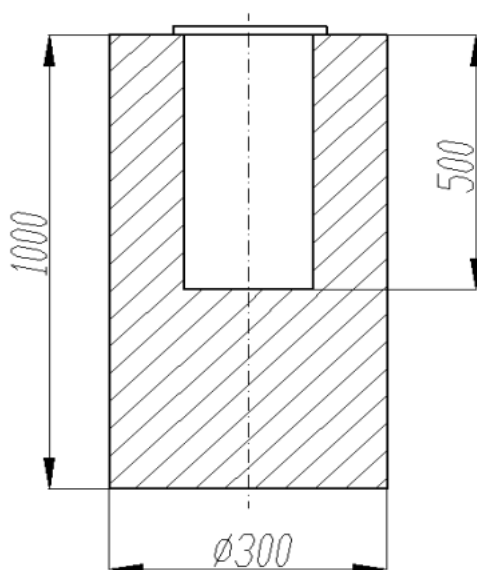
Схема устройства фундаментов (1-гильза, 2-фундамент, 3-колпак гильзы, 4-дно гильзы)
